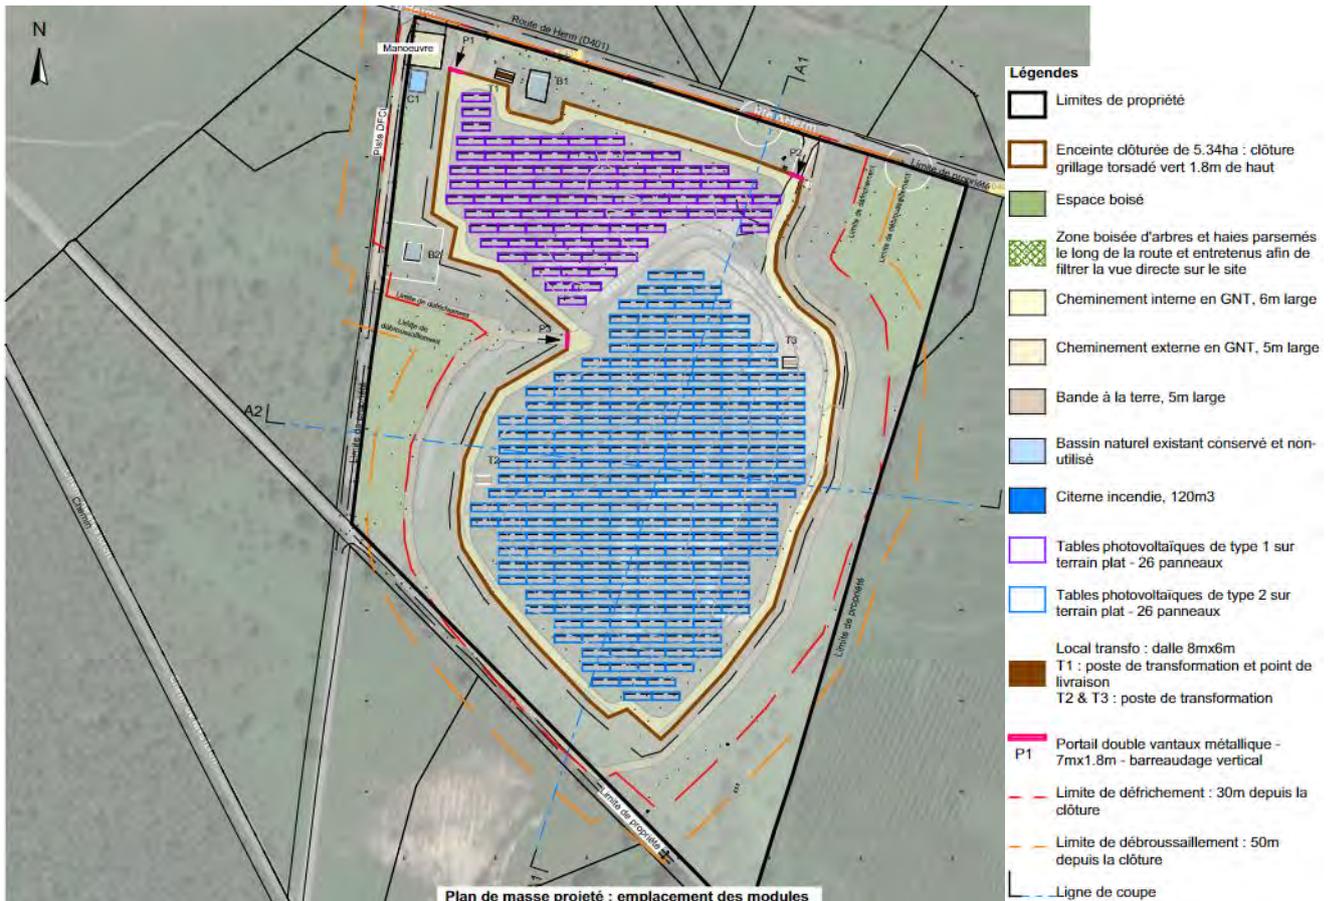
Plan de masse projeté (Source : ARCAD Architectes)
